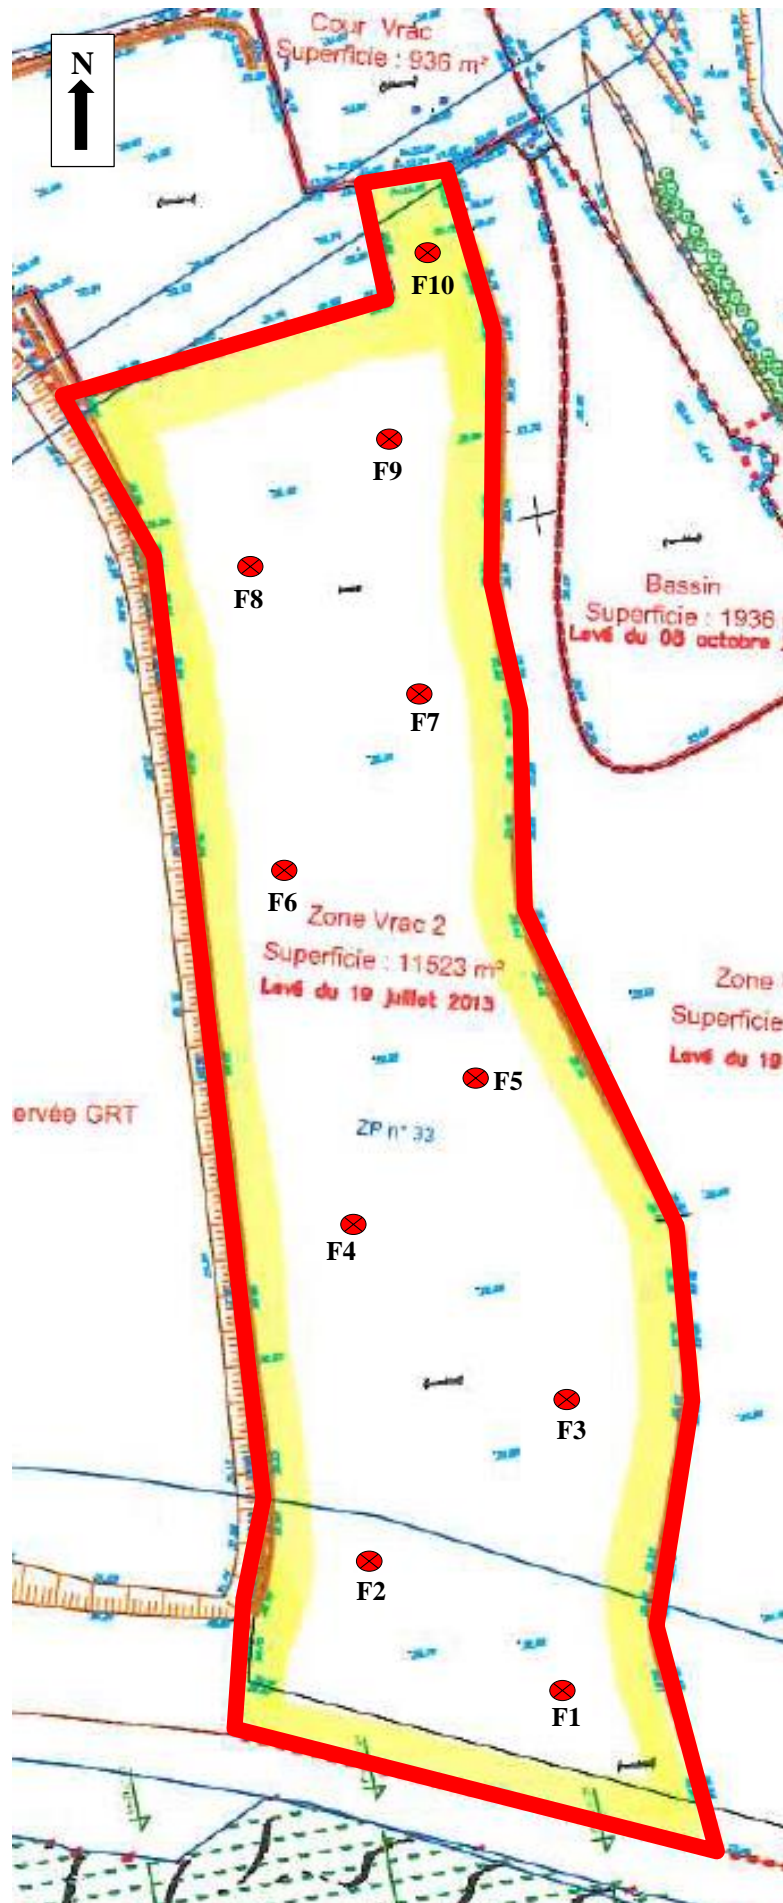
Plan d'implantation des fouilles de l'étude 17/08257/LILLE
